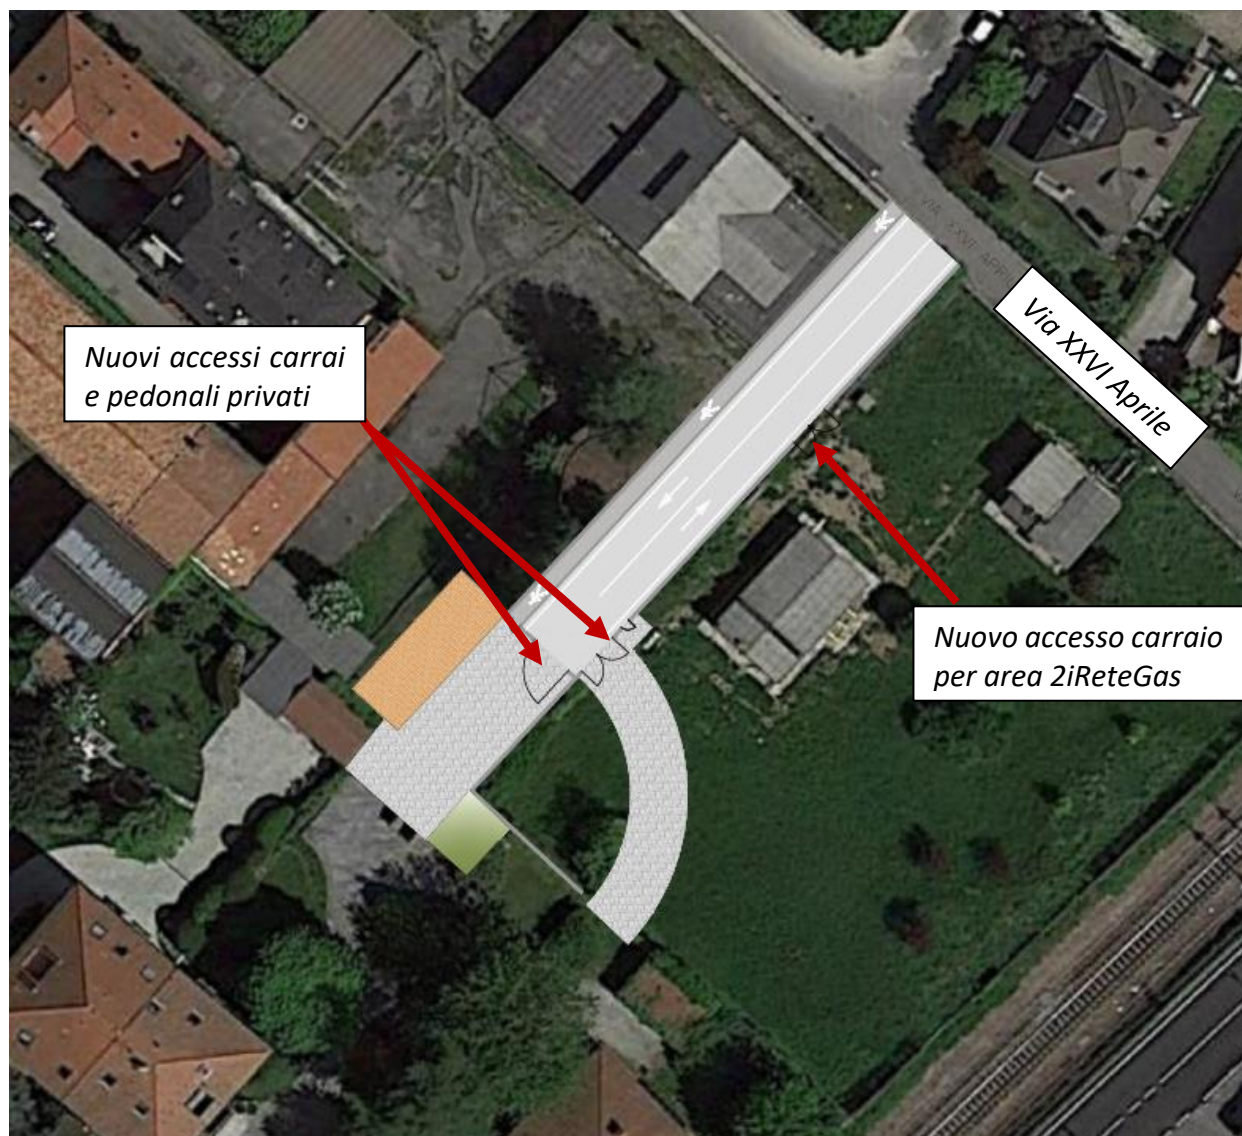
Inquadramento planimetrico nuova viabilità accesso privati
